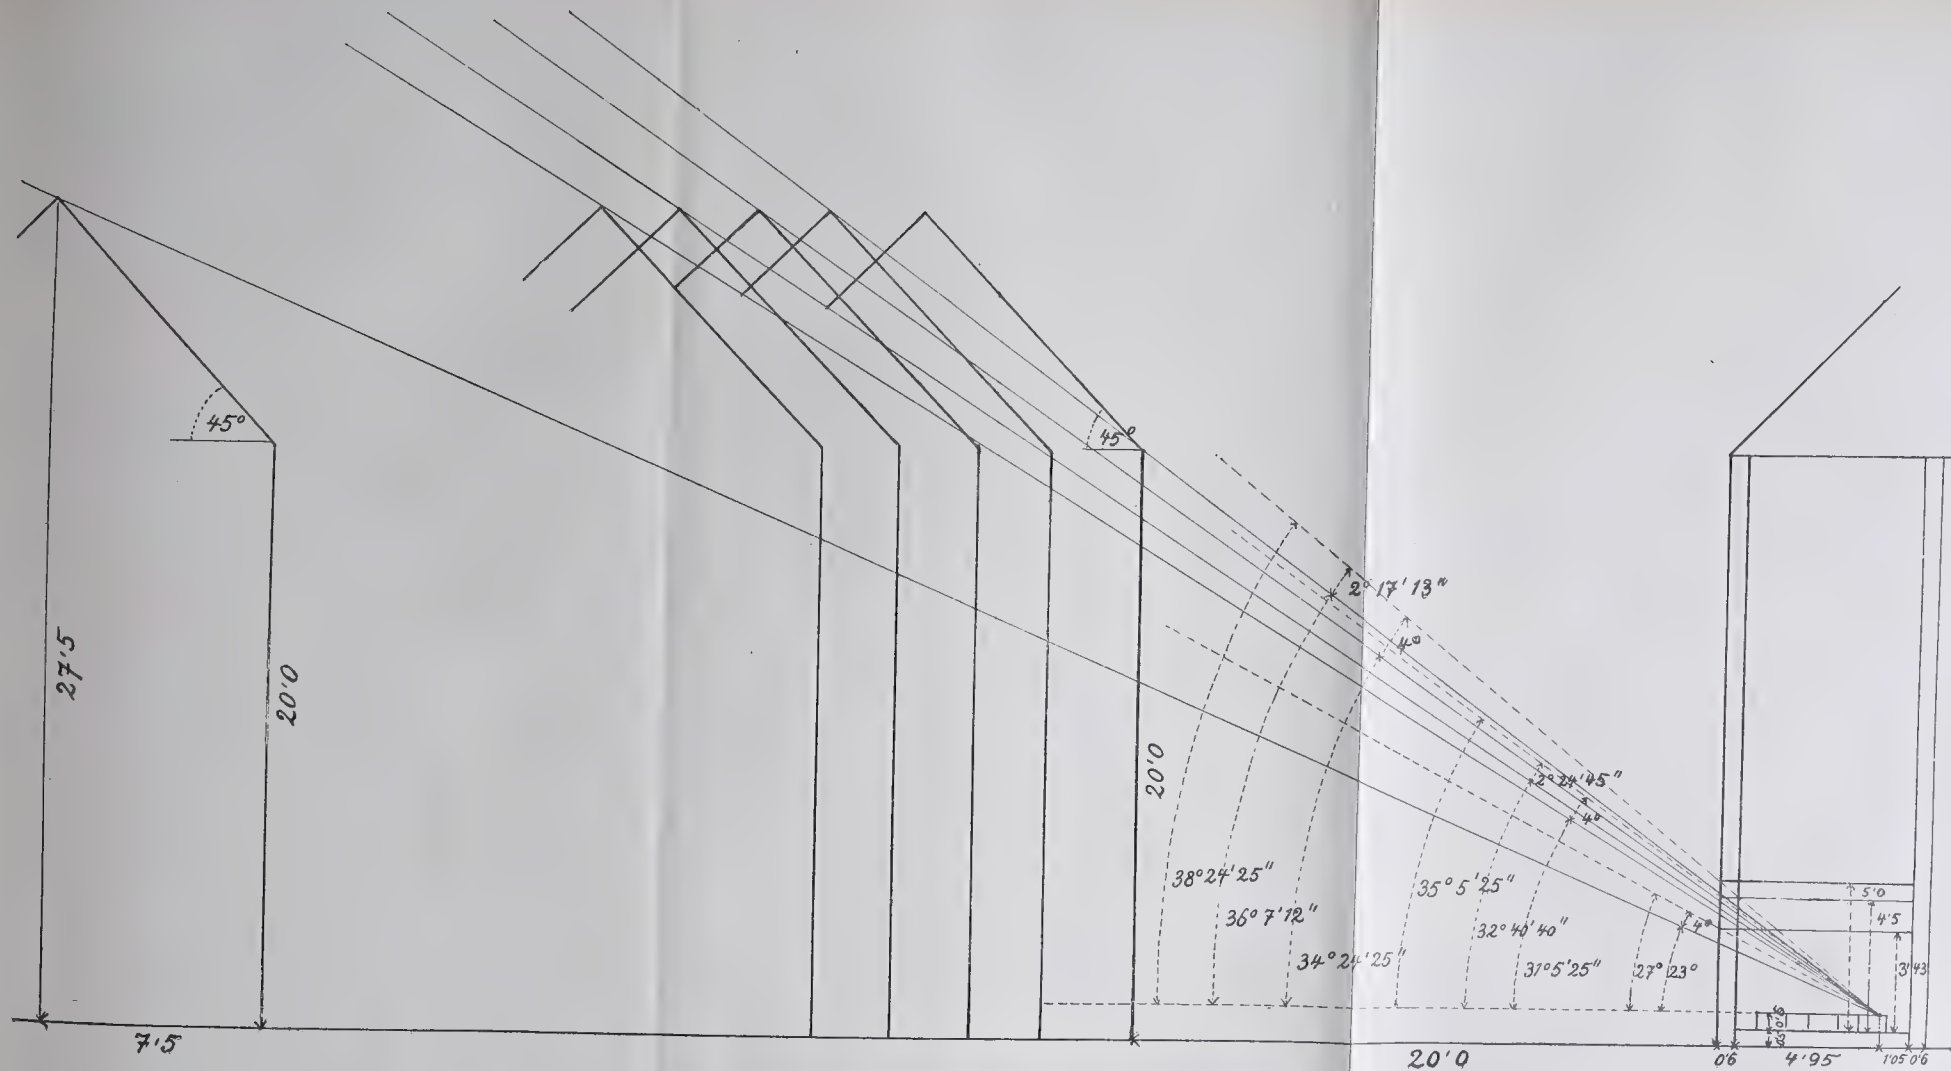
Elevationswinkel, Öffnungswinkel und Minimalabstand der Gebäude.
